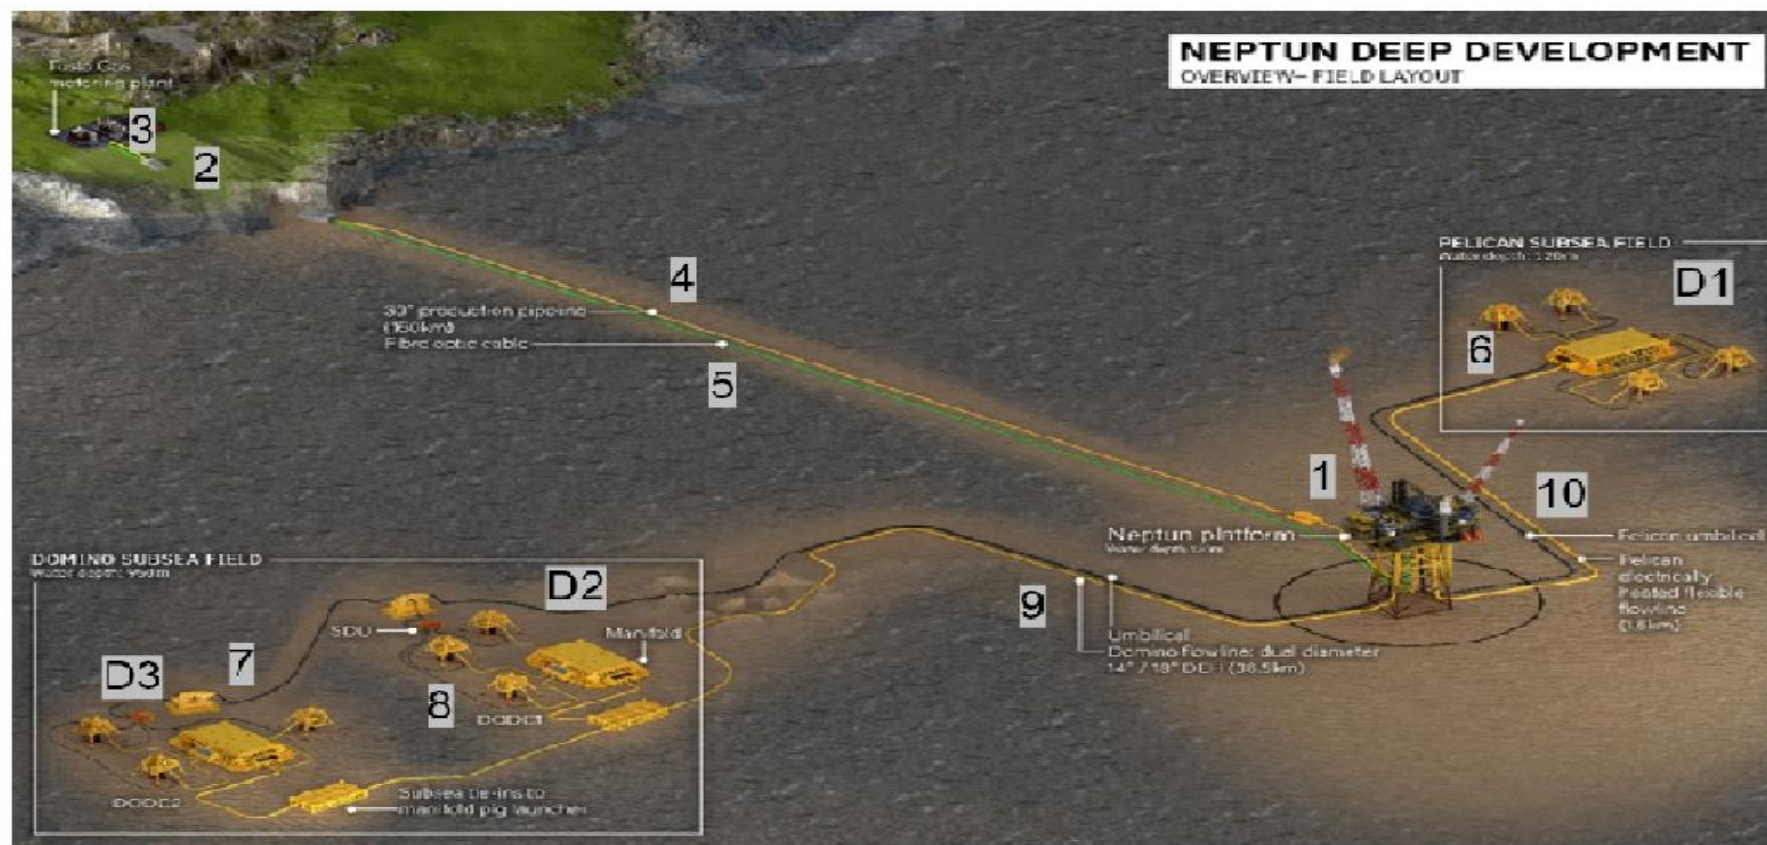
Identificarea zonelor de instalare/ construire componente proiect
